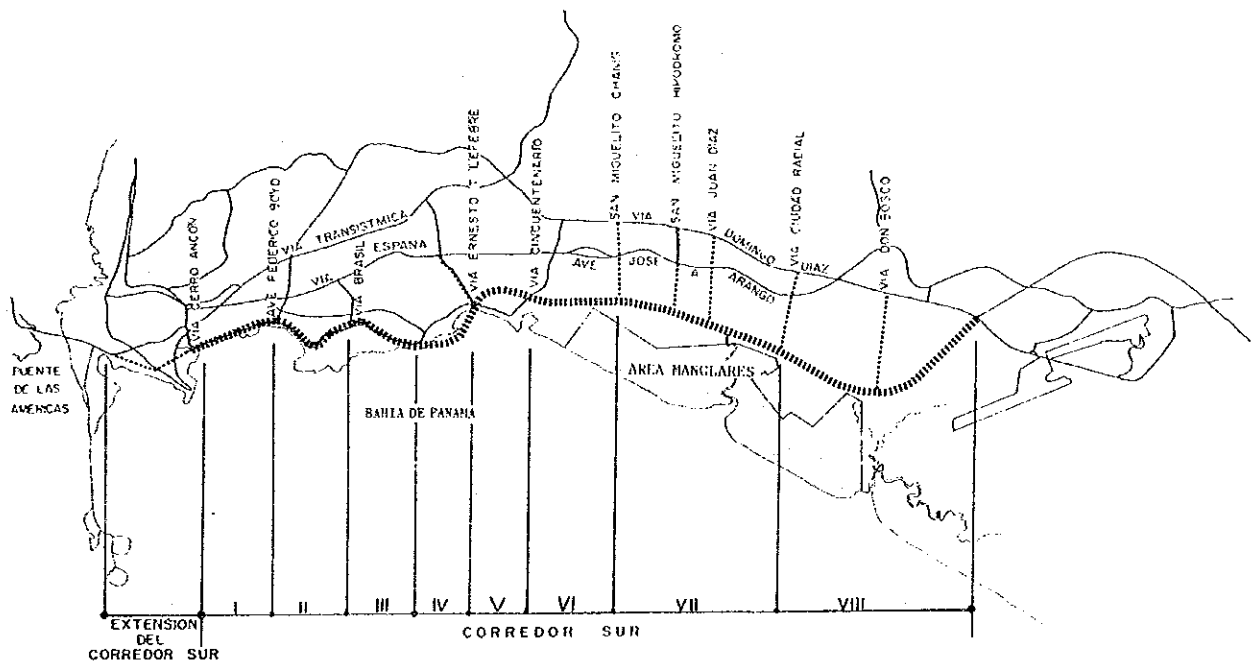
SECCIONES DIVIDIDAS DEL CORREDOR SUR
